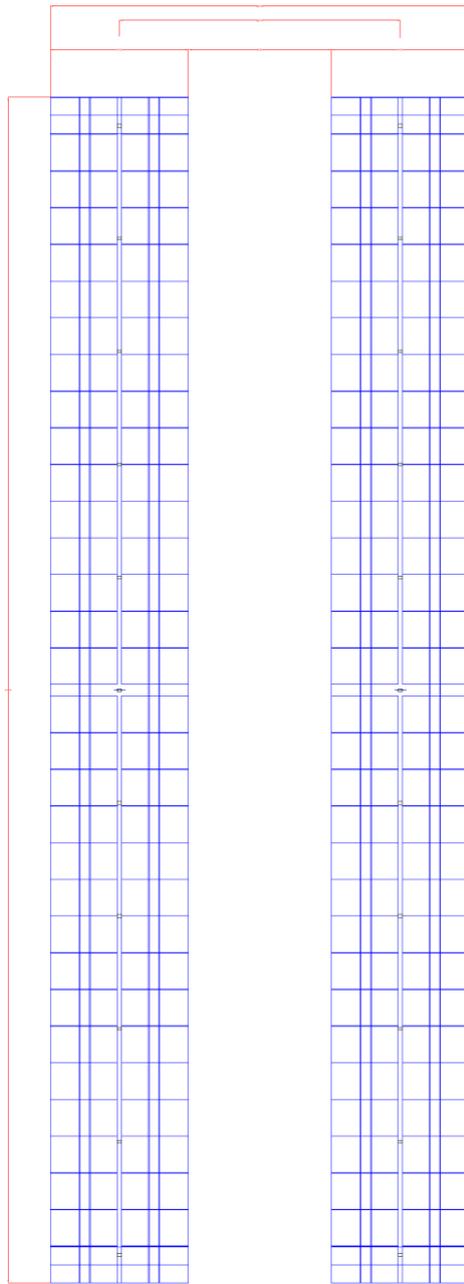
Vista in pianta dei tracker fotovoltaici previsti a progetto
